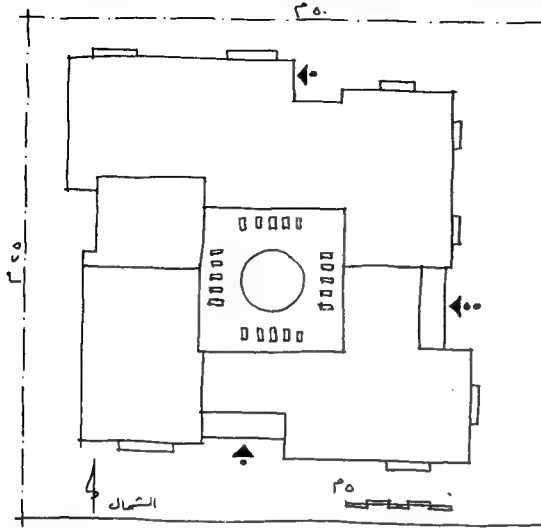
مسقط أفقي للدور الأول في المثال الخامس
